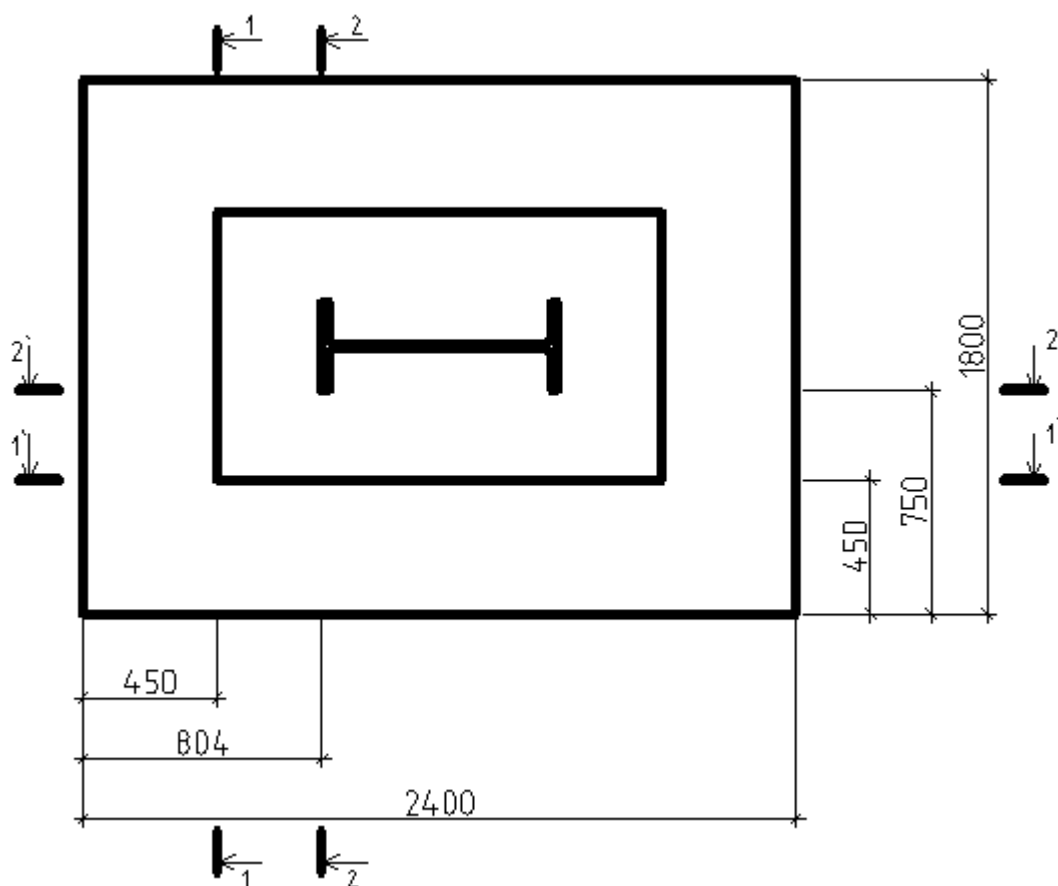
Схема к расчету арматуры плитной части столбчатого фундамента
